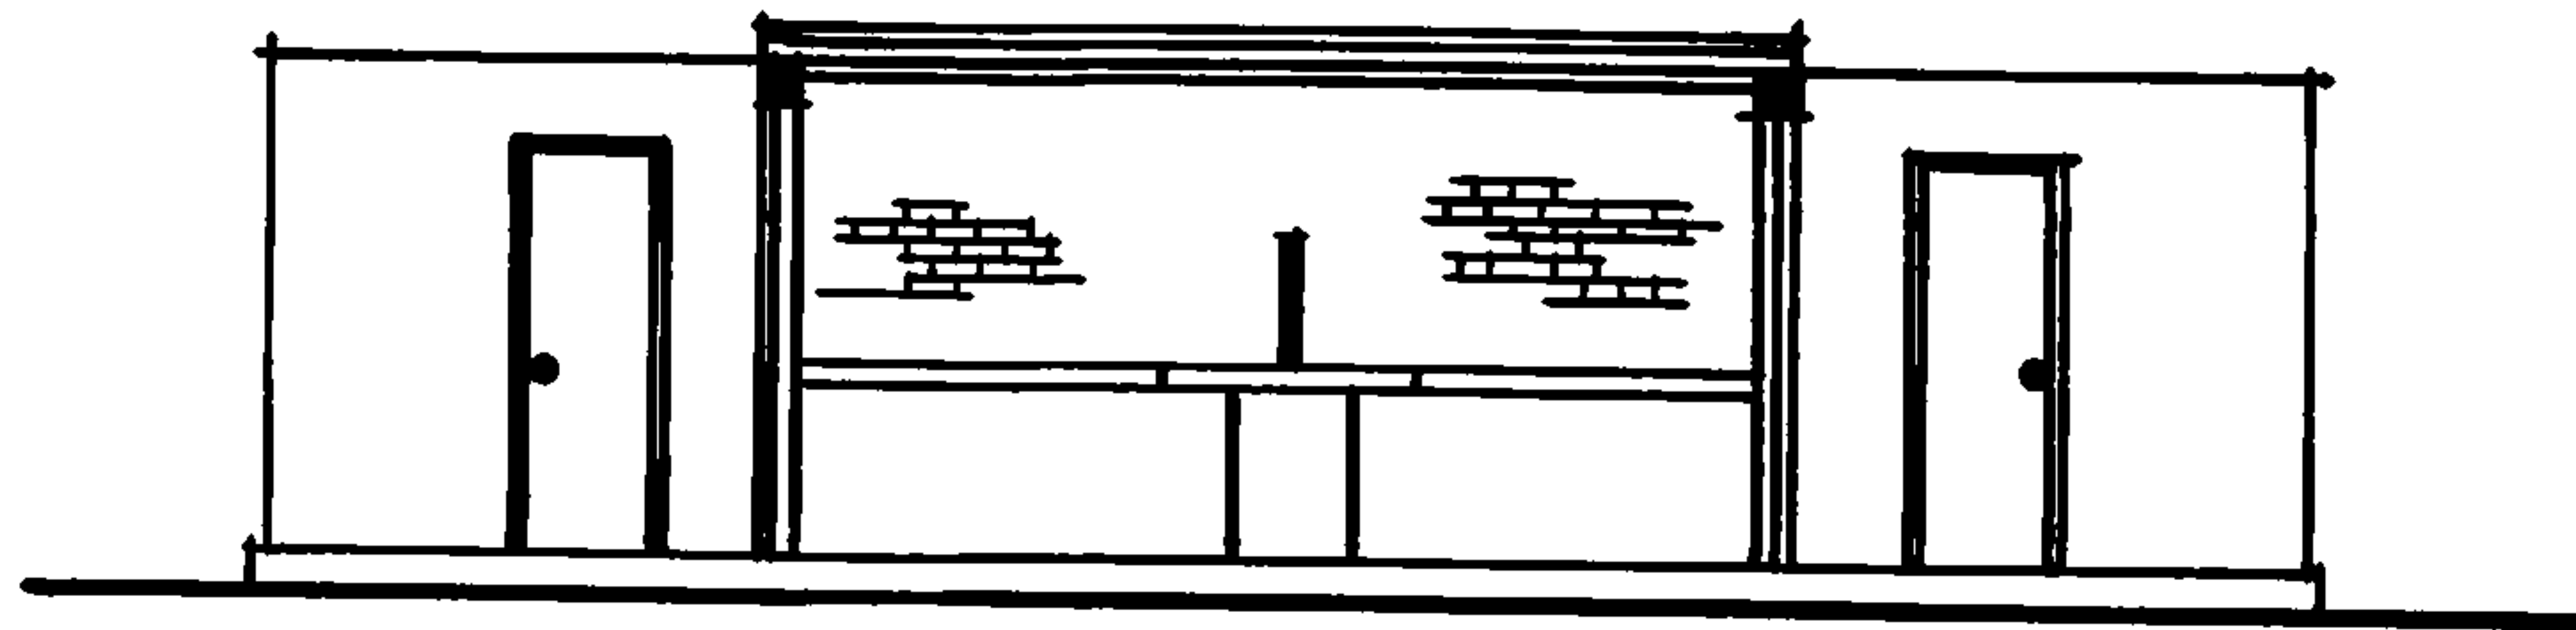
Фасад душевой на 12 сеток в осях 1-5
